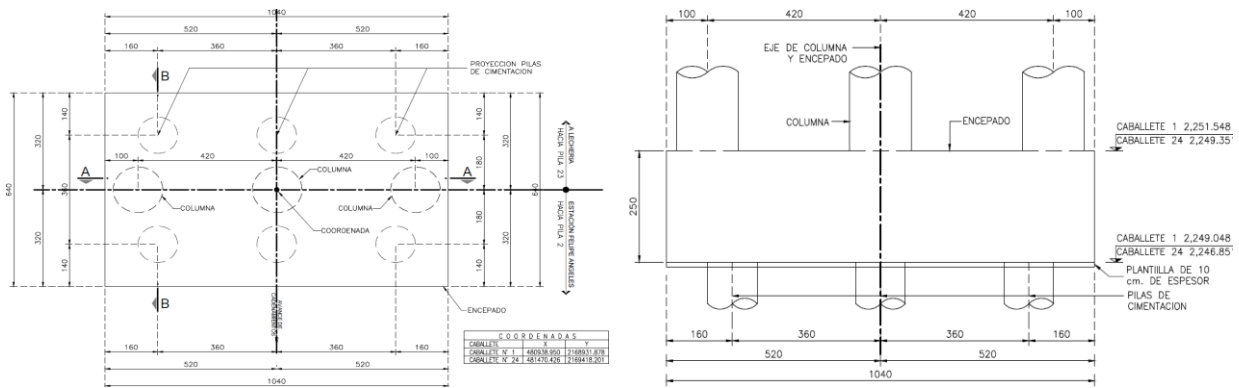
y 87 ARI Ingeniería (2023) "Geometría de zapatas para estribos (Apoyo 1 y 24)"
